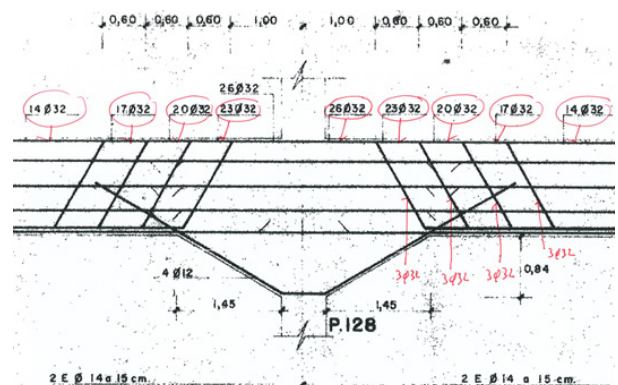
Detalle de armado del proyecto original de los pórticos principales
